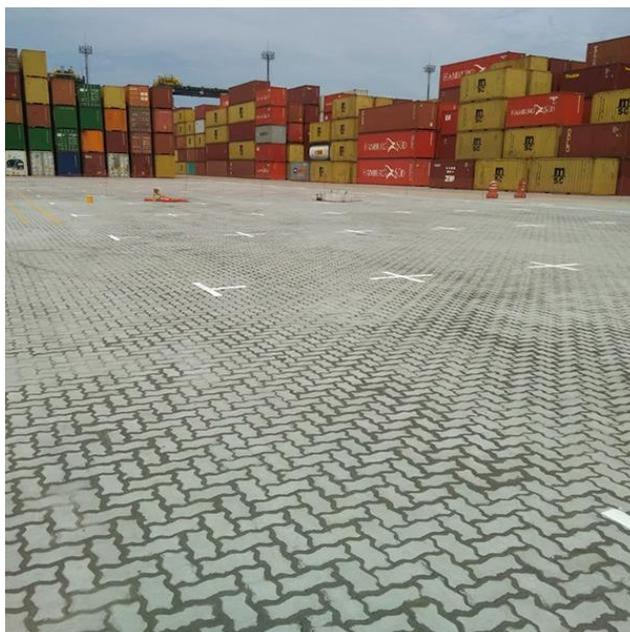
Exemplo de piso intertravado aplicado em um Pátio de Contêineres.
